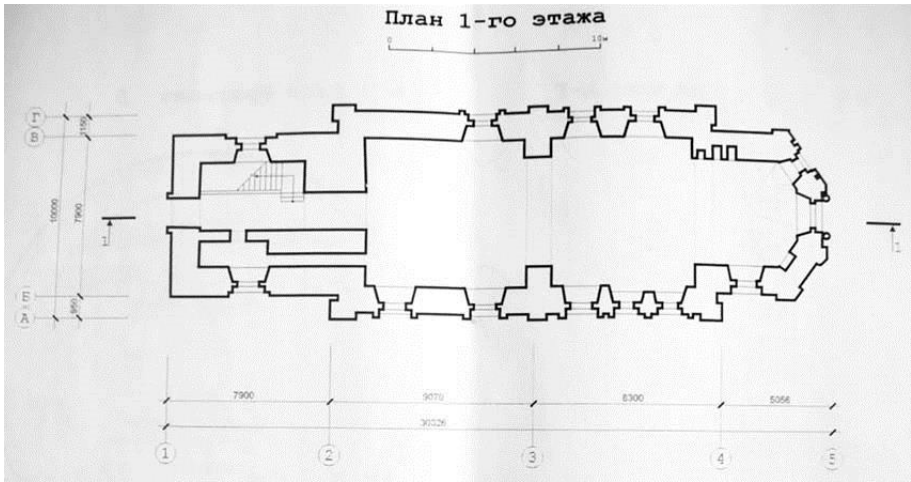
План первого этажа здания из Проекта восстановления колокольни [14]
